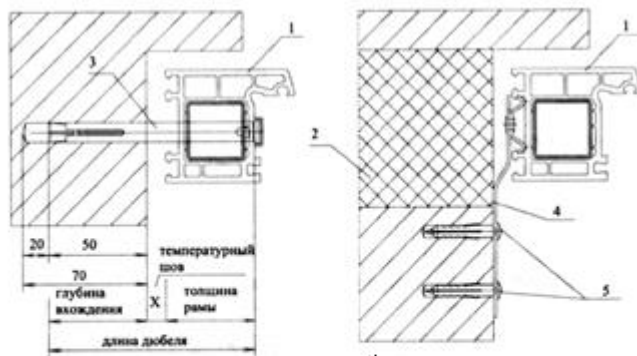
Закрепление окна из ПВХ в наружных стенах различной конструкции: а) сплошная кирпичная стена; б) кирпичная стена с пористым эффективным утеплителем: 1 – оконная рама, 2 – утеплитель в стене, 3 – дюбель, 4 – монтажная пластина, 5 – анкер
